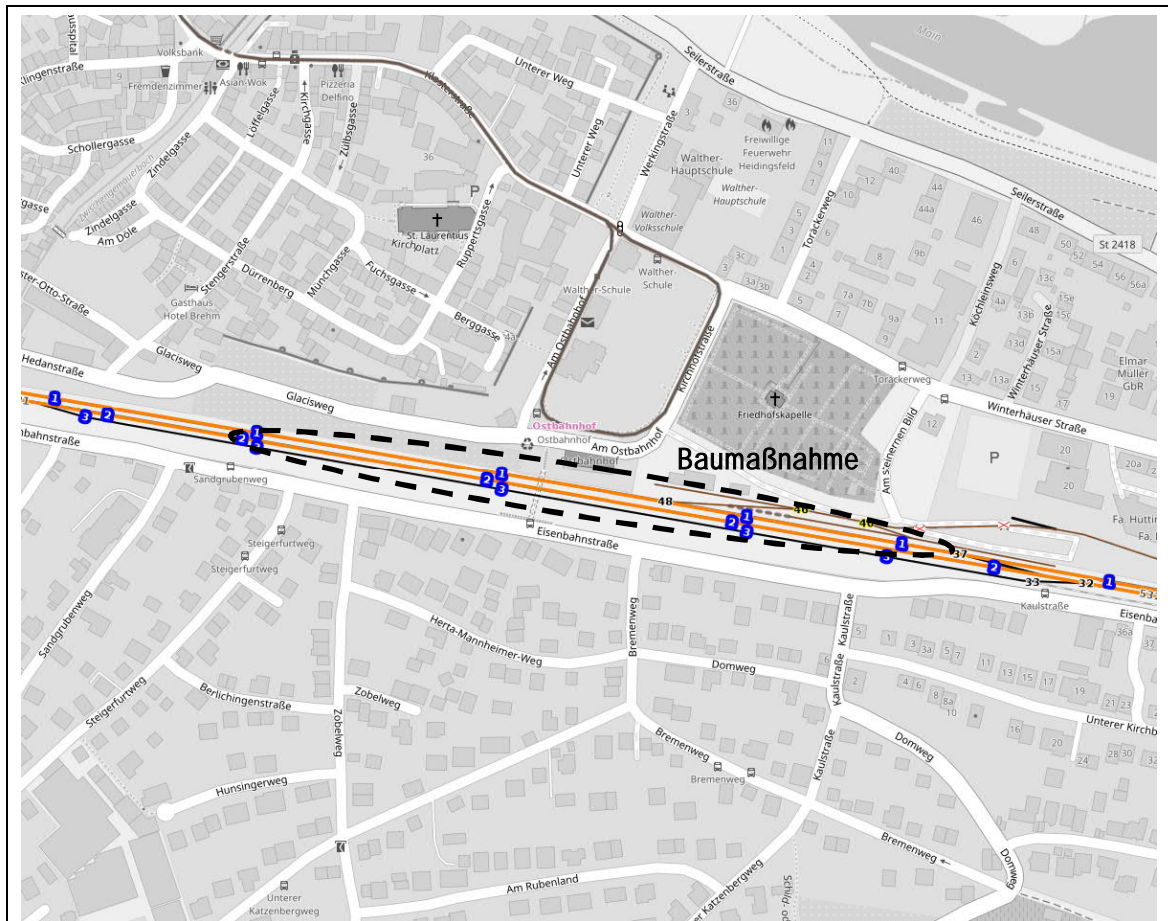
Übersichtslageplan mit Darstellung zur Lage der Baumaßnahme (Quelle: BayernAtlas)
